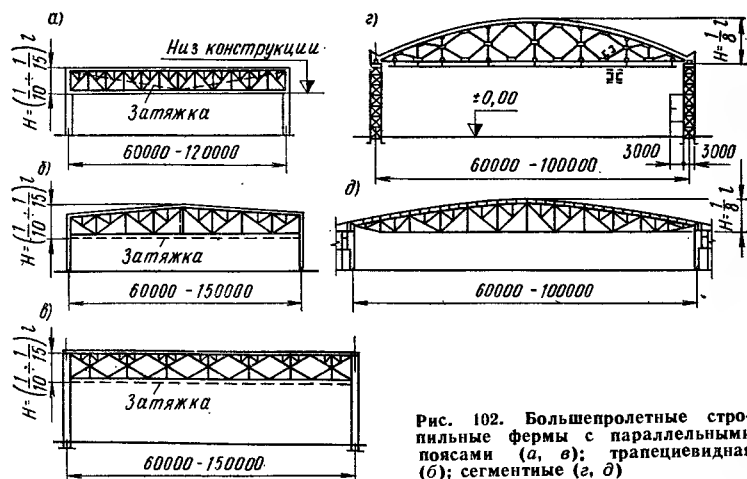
Большепролетные стропильные фермы с параллельными поясами (а, в); трапецевидная (б); сегментные (с, д)
